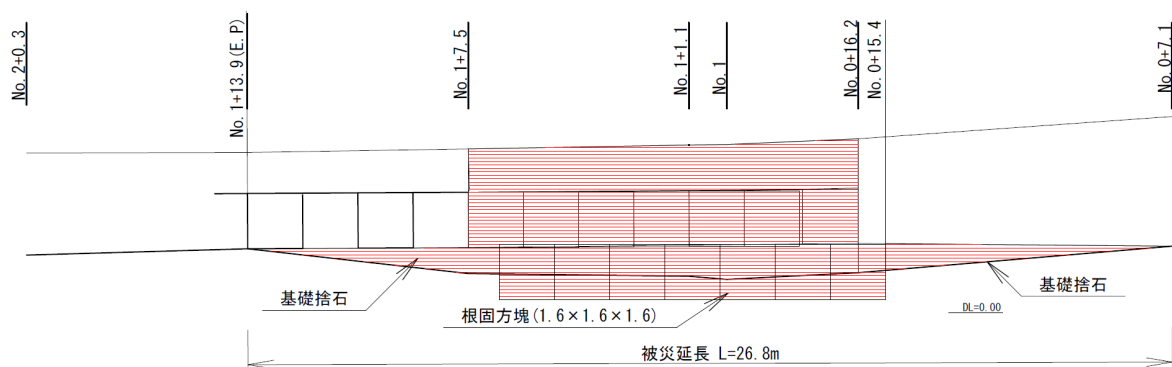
No. 8 南海浜埋立地導流堤の縦断面図（南側）（被災後）
